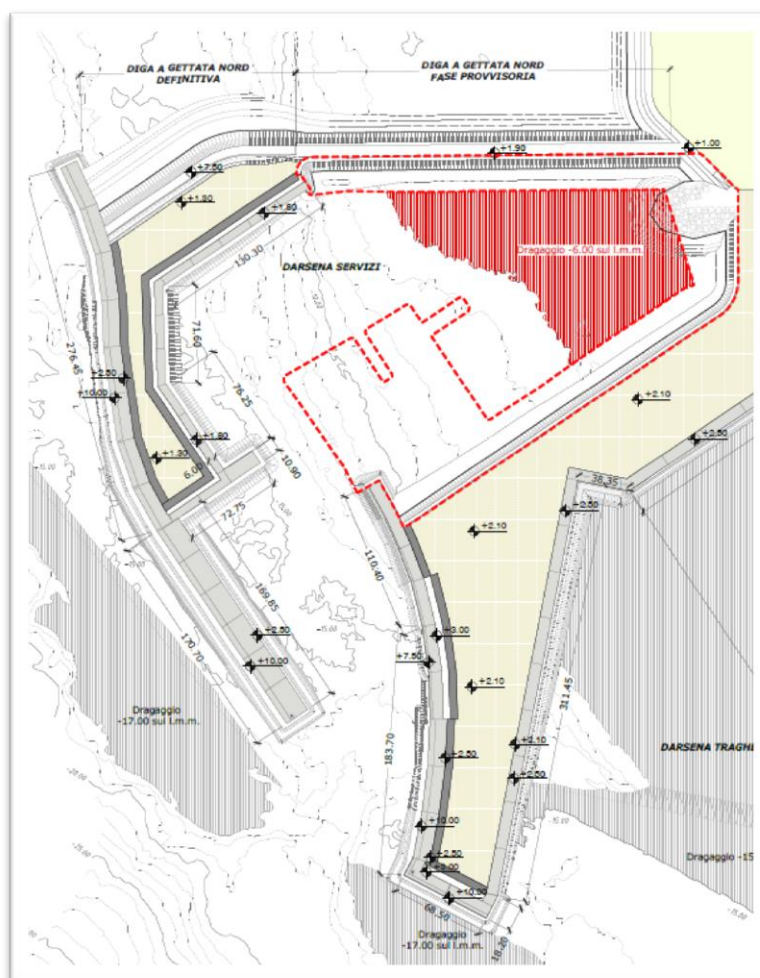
Darsena Servizi: Stralcio planimetria di perizia di variante N°1 – Opere I stralcio funzionale
